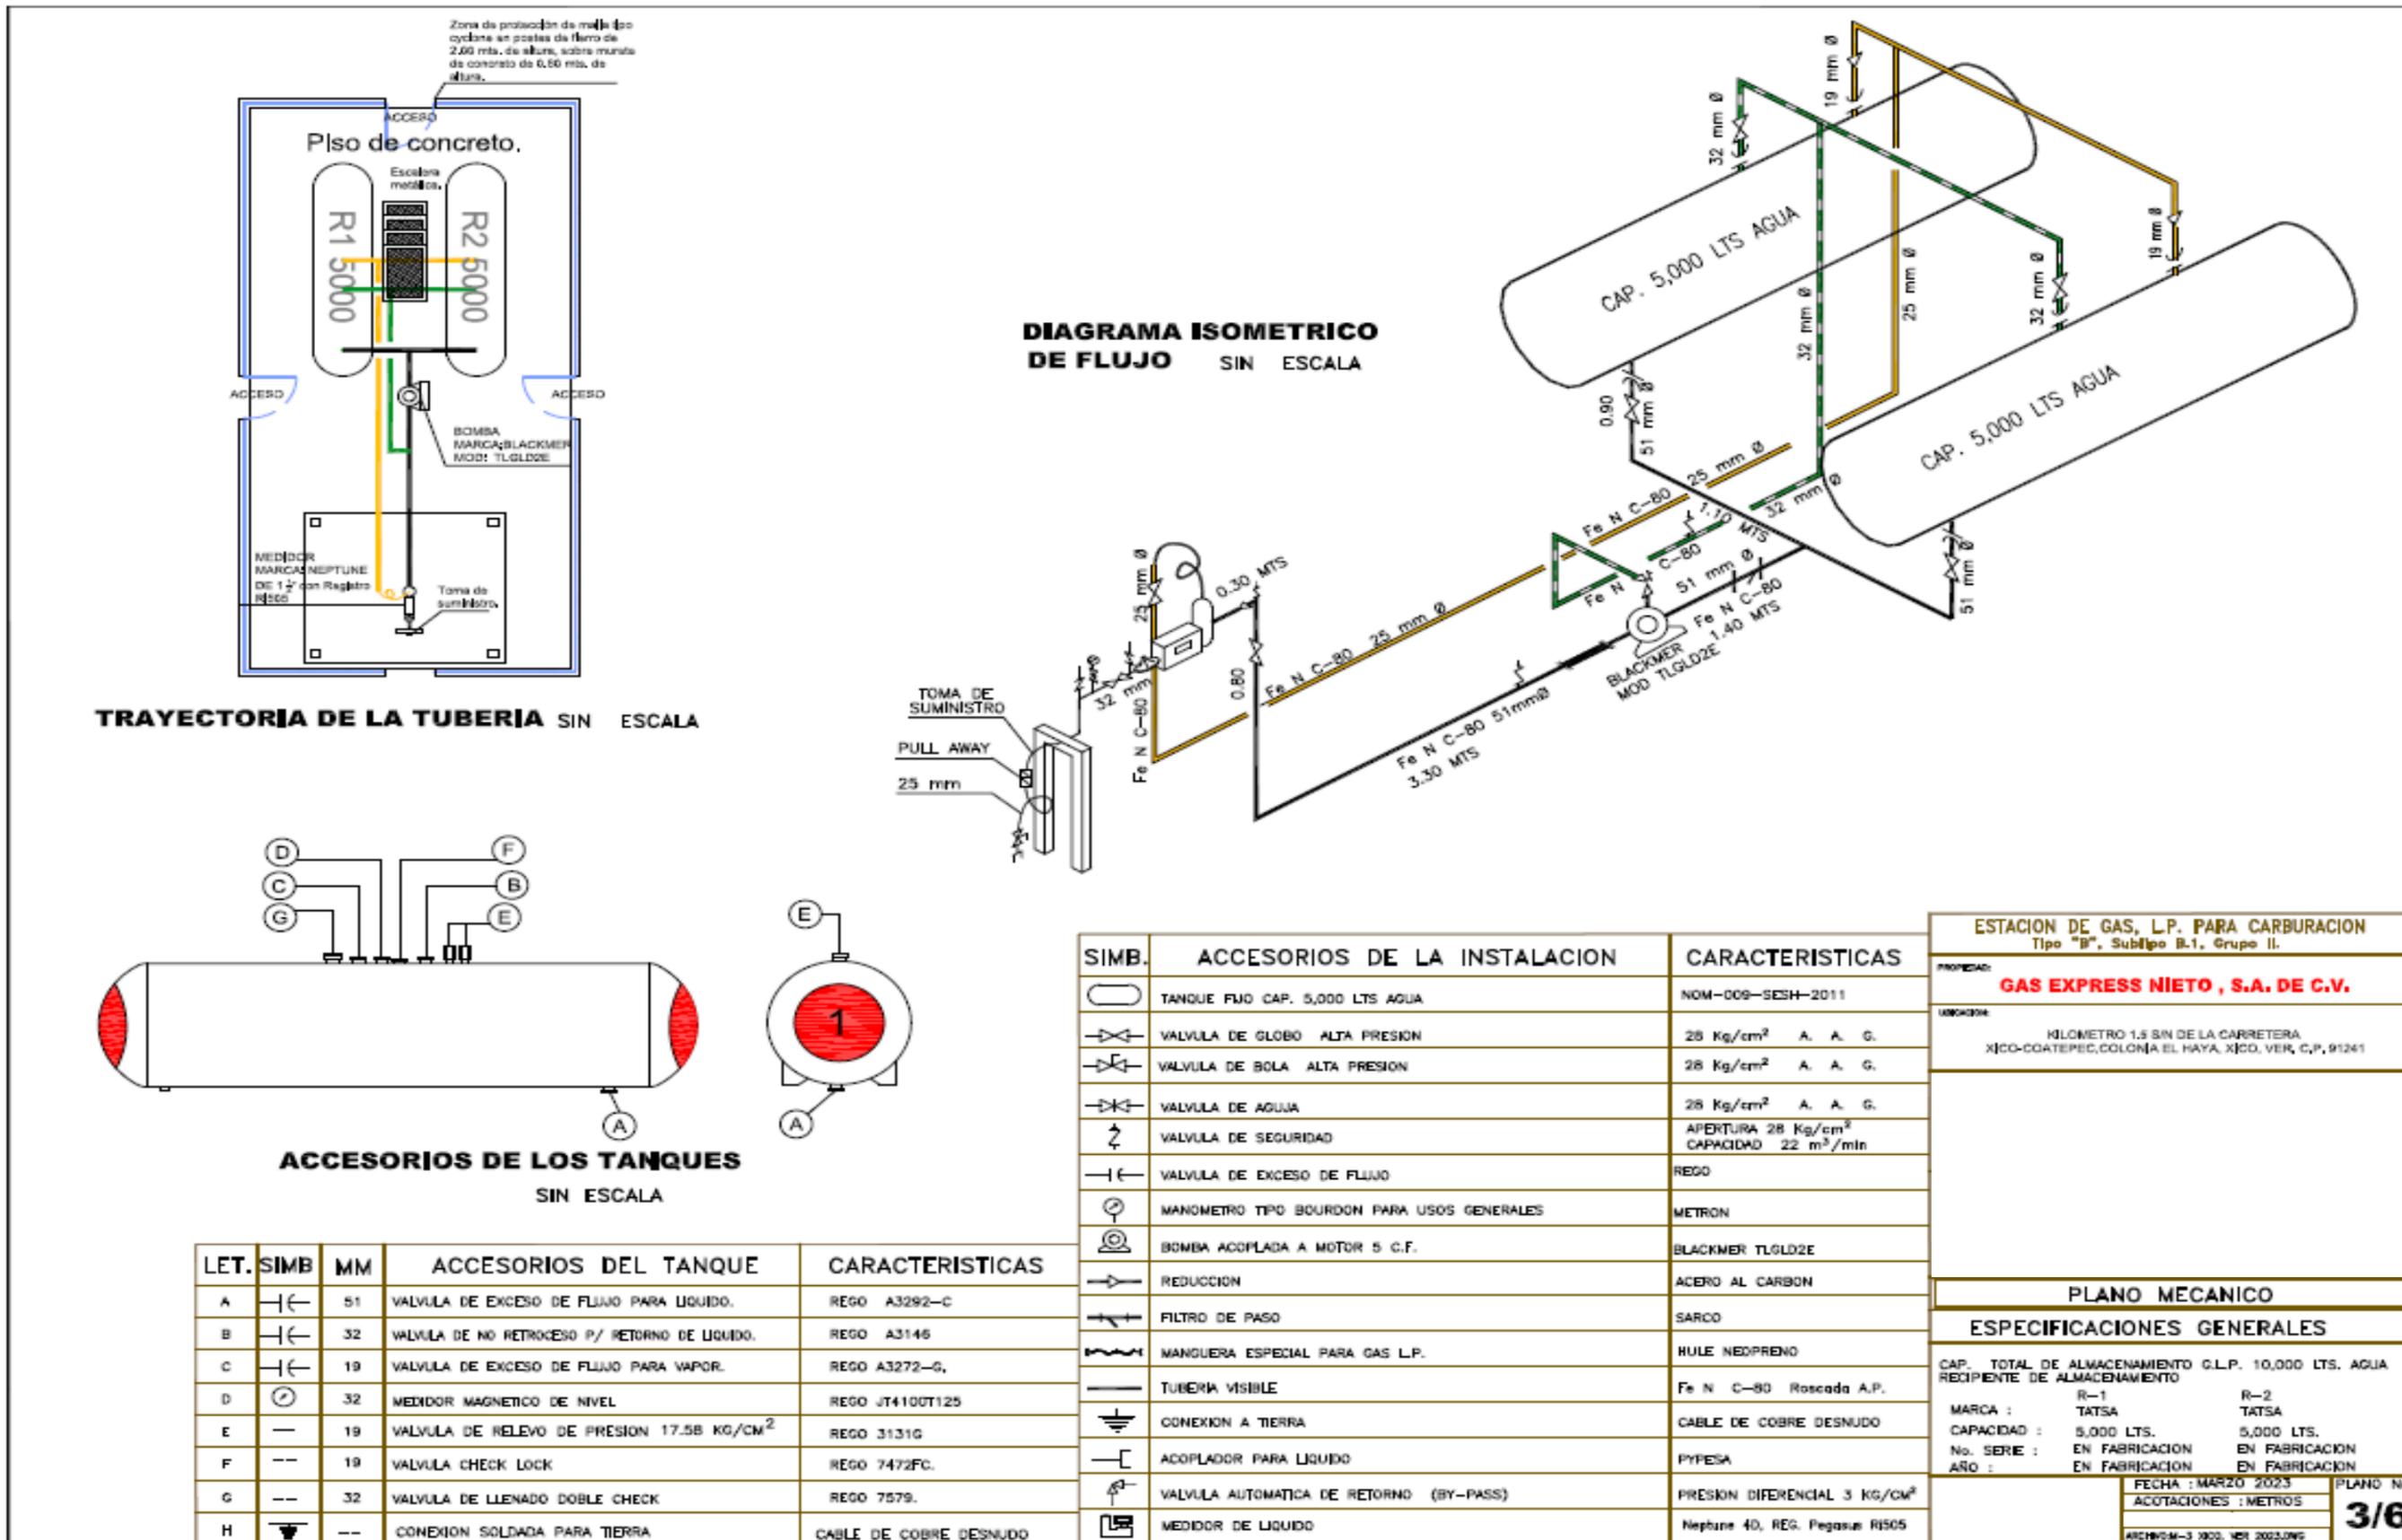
Plano de arreglo mecánico con detalles de equipamiento dentro de la estación proyectada.
